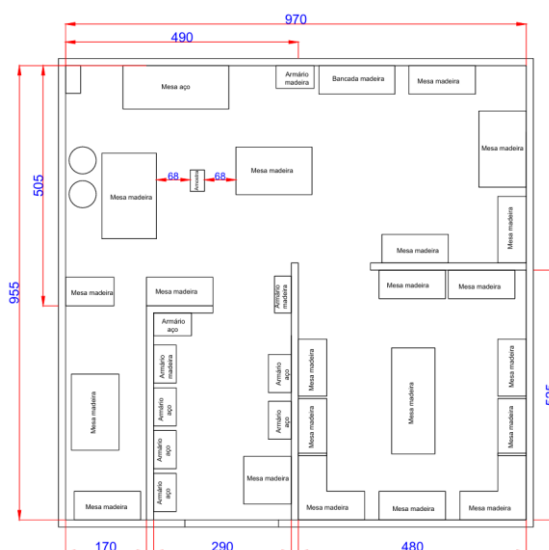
Planta baixa do LAV e mapeamento da amostra.
